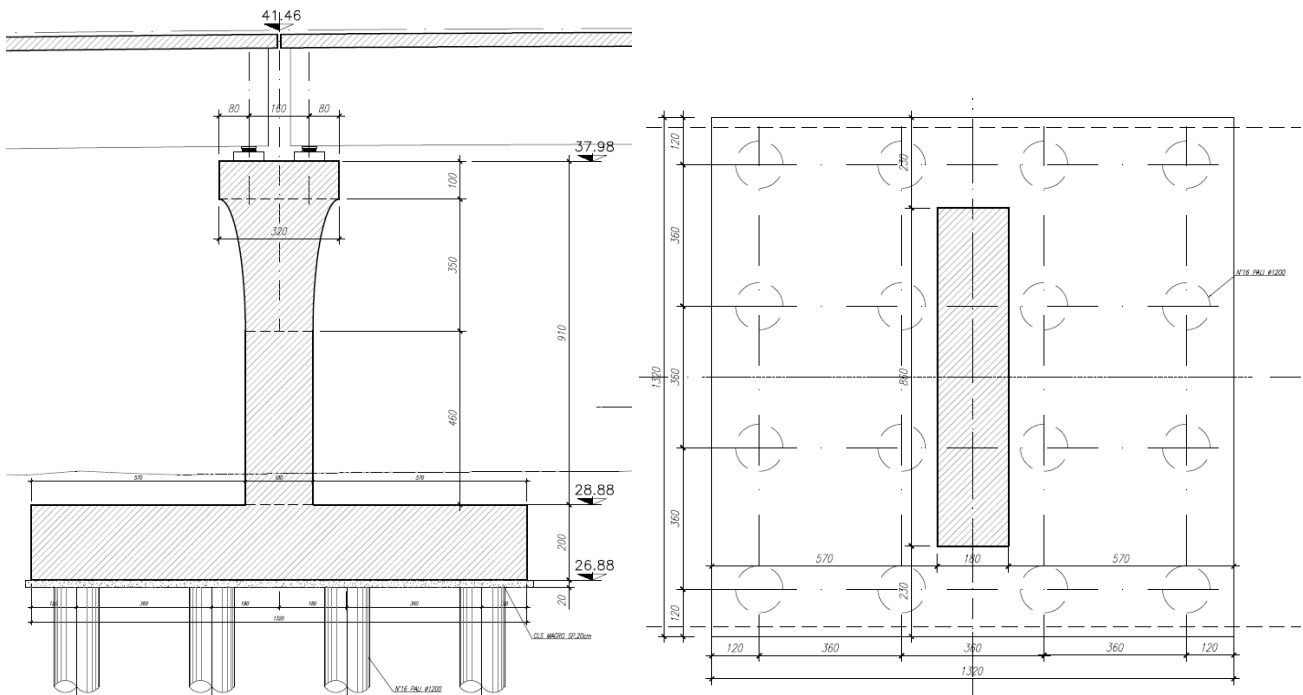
Sezione trasversale e Pianta delle fondazioni pile
